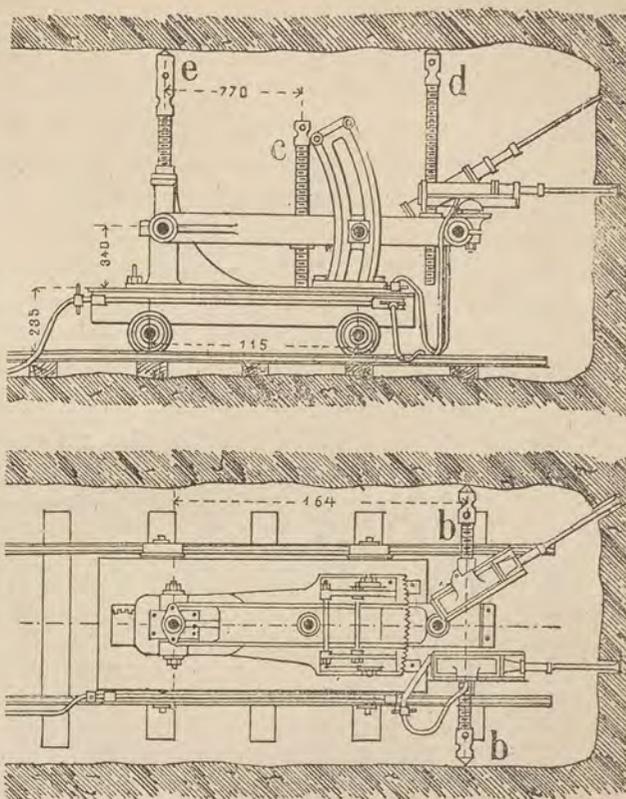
L'affusto a carrello di Ingersoll per due perforatrici.
